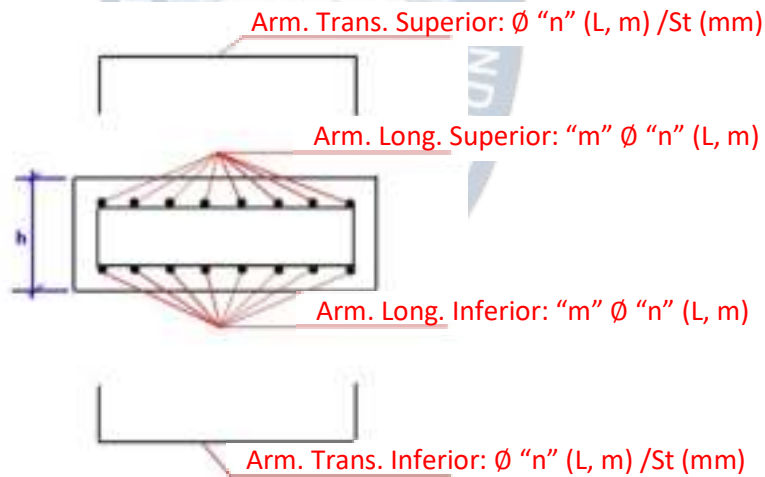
Detalle de la Armadura de una escalera típica vista transversal de un tramo
